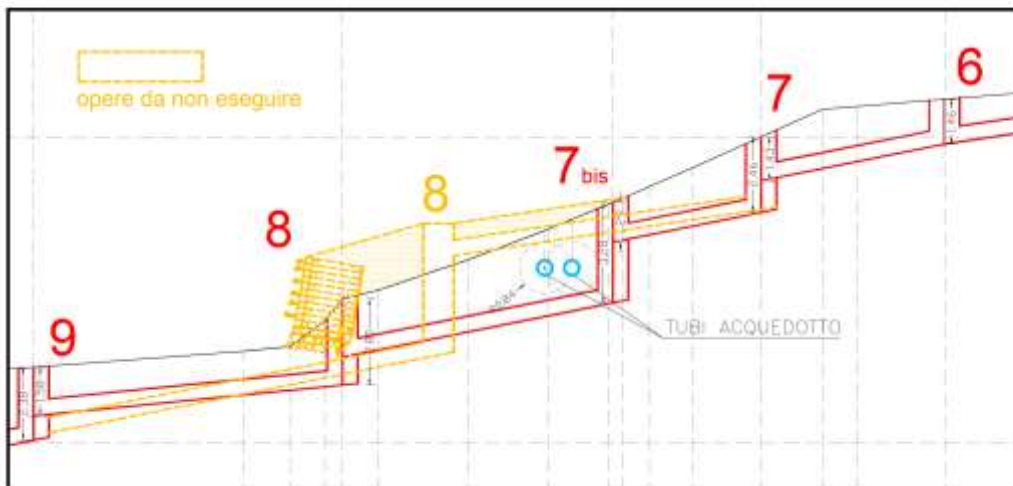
Stralcio della tavola di profilo longitudinale: dettaglio della soluzione alternativa di sottopasso dei tubi
